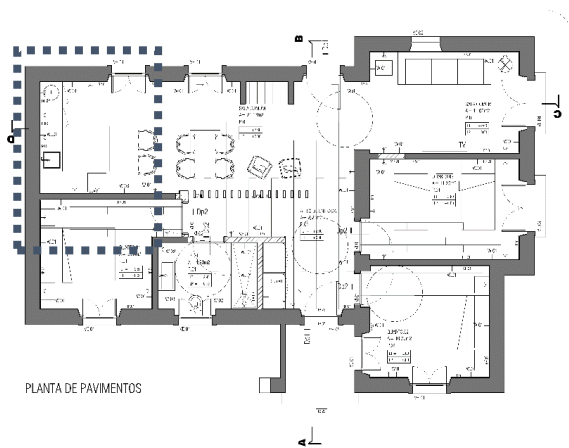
Planta de Pavimentos - In: Arq. Carla Vieira da Silva
